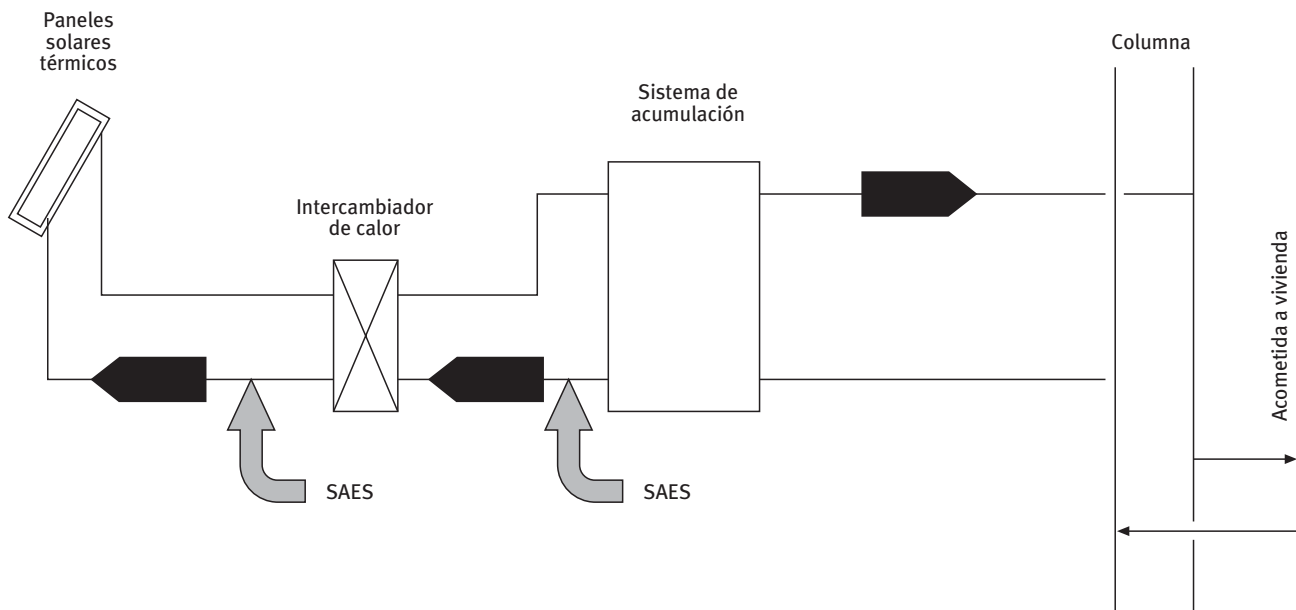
Preparación de ACS de sistema solar para viviendas con calderas murales
